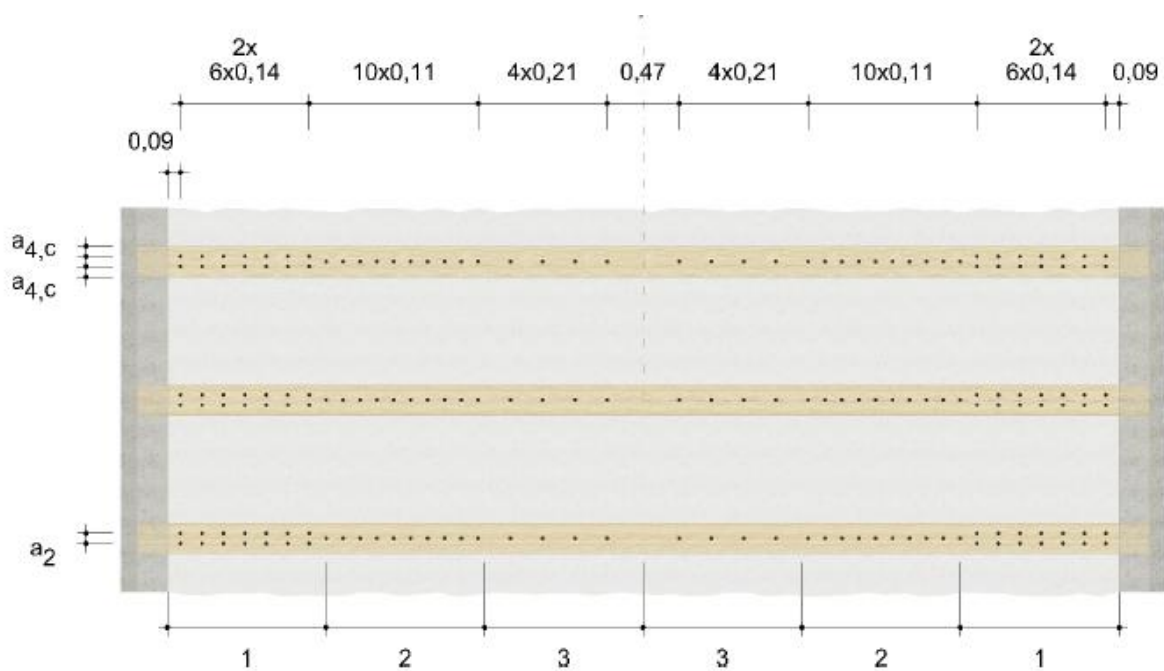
Prikaz spregnute konstrukcije (drvo-beton)
